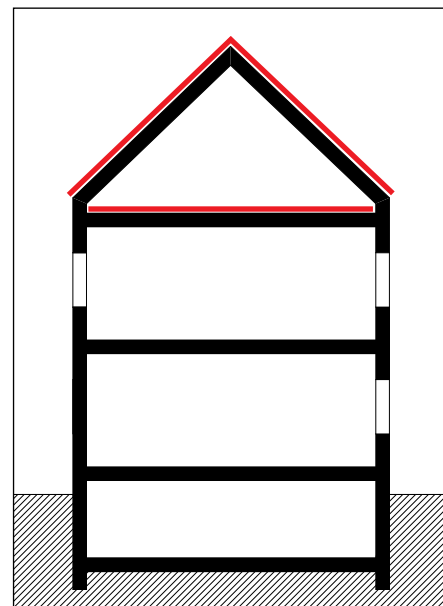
Nachträgliche Aufdämmung einer Geschossdecke zu einem unbeheizten Dachraum
